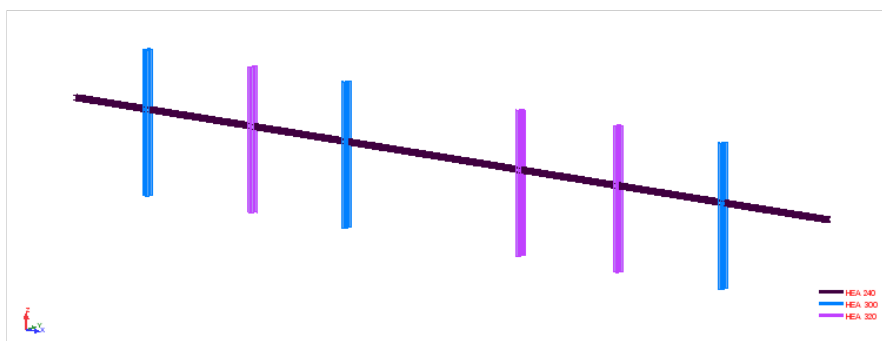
Geometria do modelo de cálculo das vigas e pilares metálicos da fachada.
